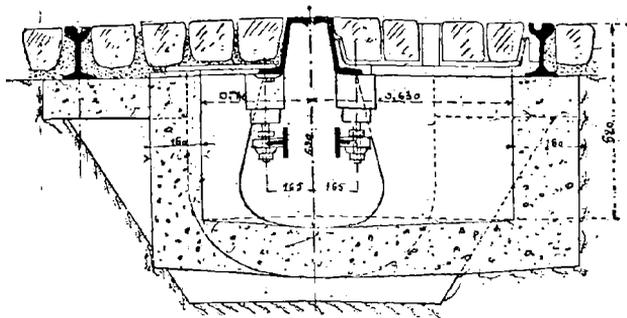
Caniveau de la ligne Charenton-Bastille. — Coupe transversale sur regard.
